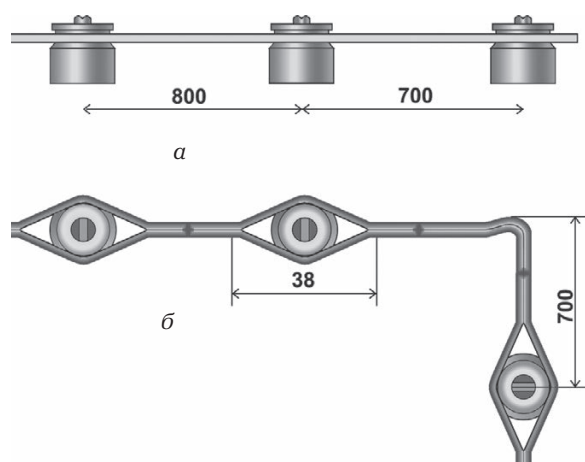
Крепление проводов на роликах на стене (мм): а — вид сбоку; б — вид сверху
